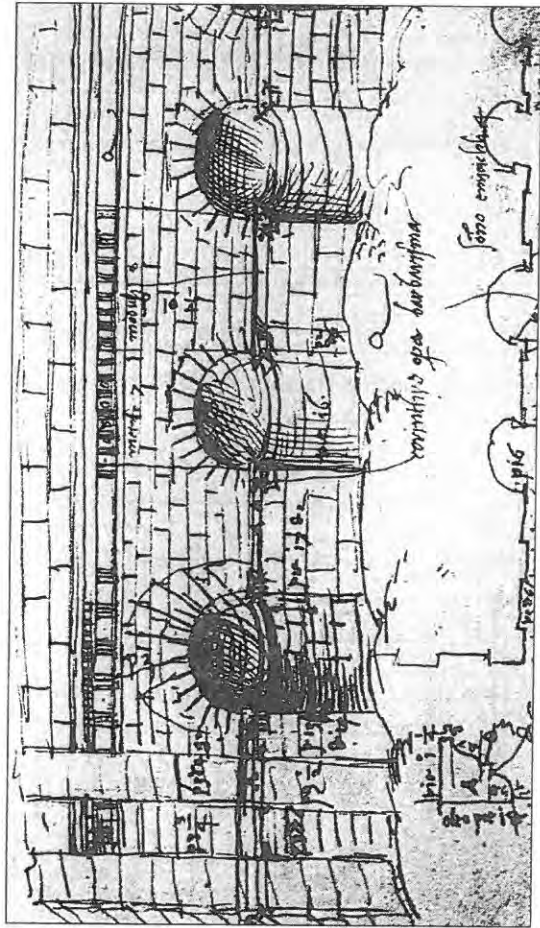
B. Peruzzi: Todi; dibujo, planta y fachada, de muralla de época romana.
